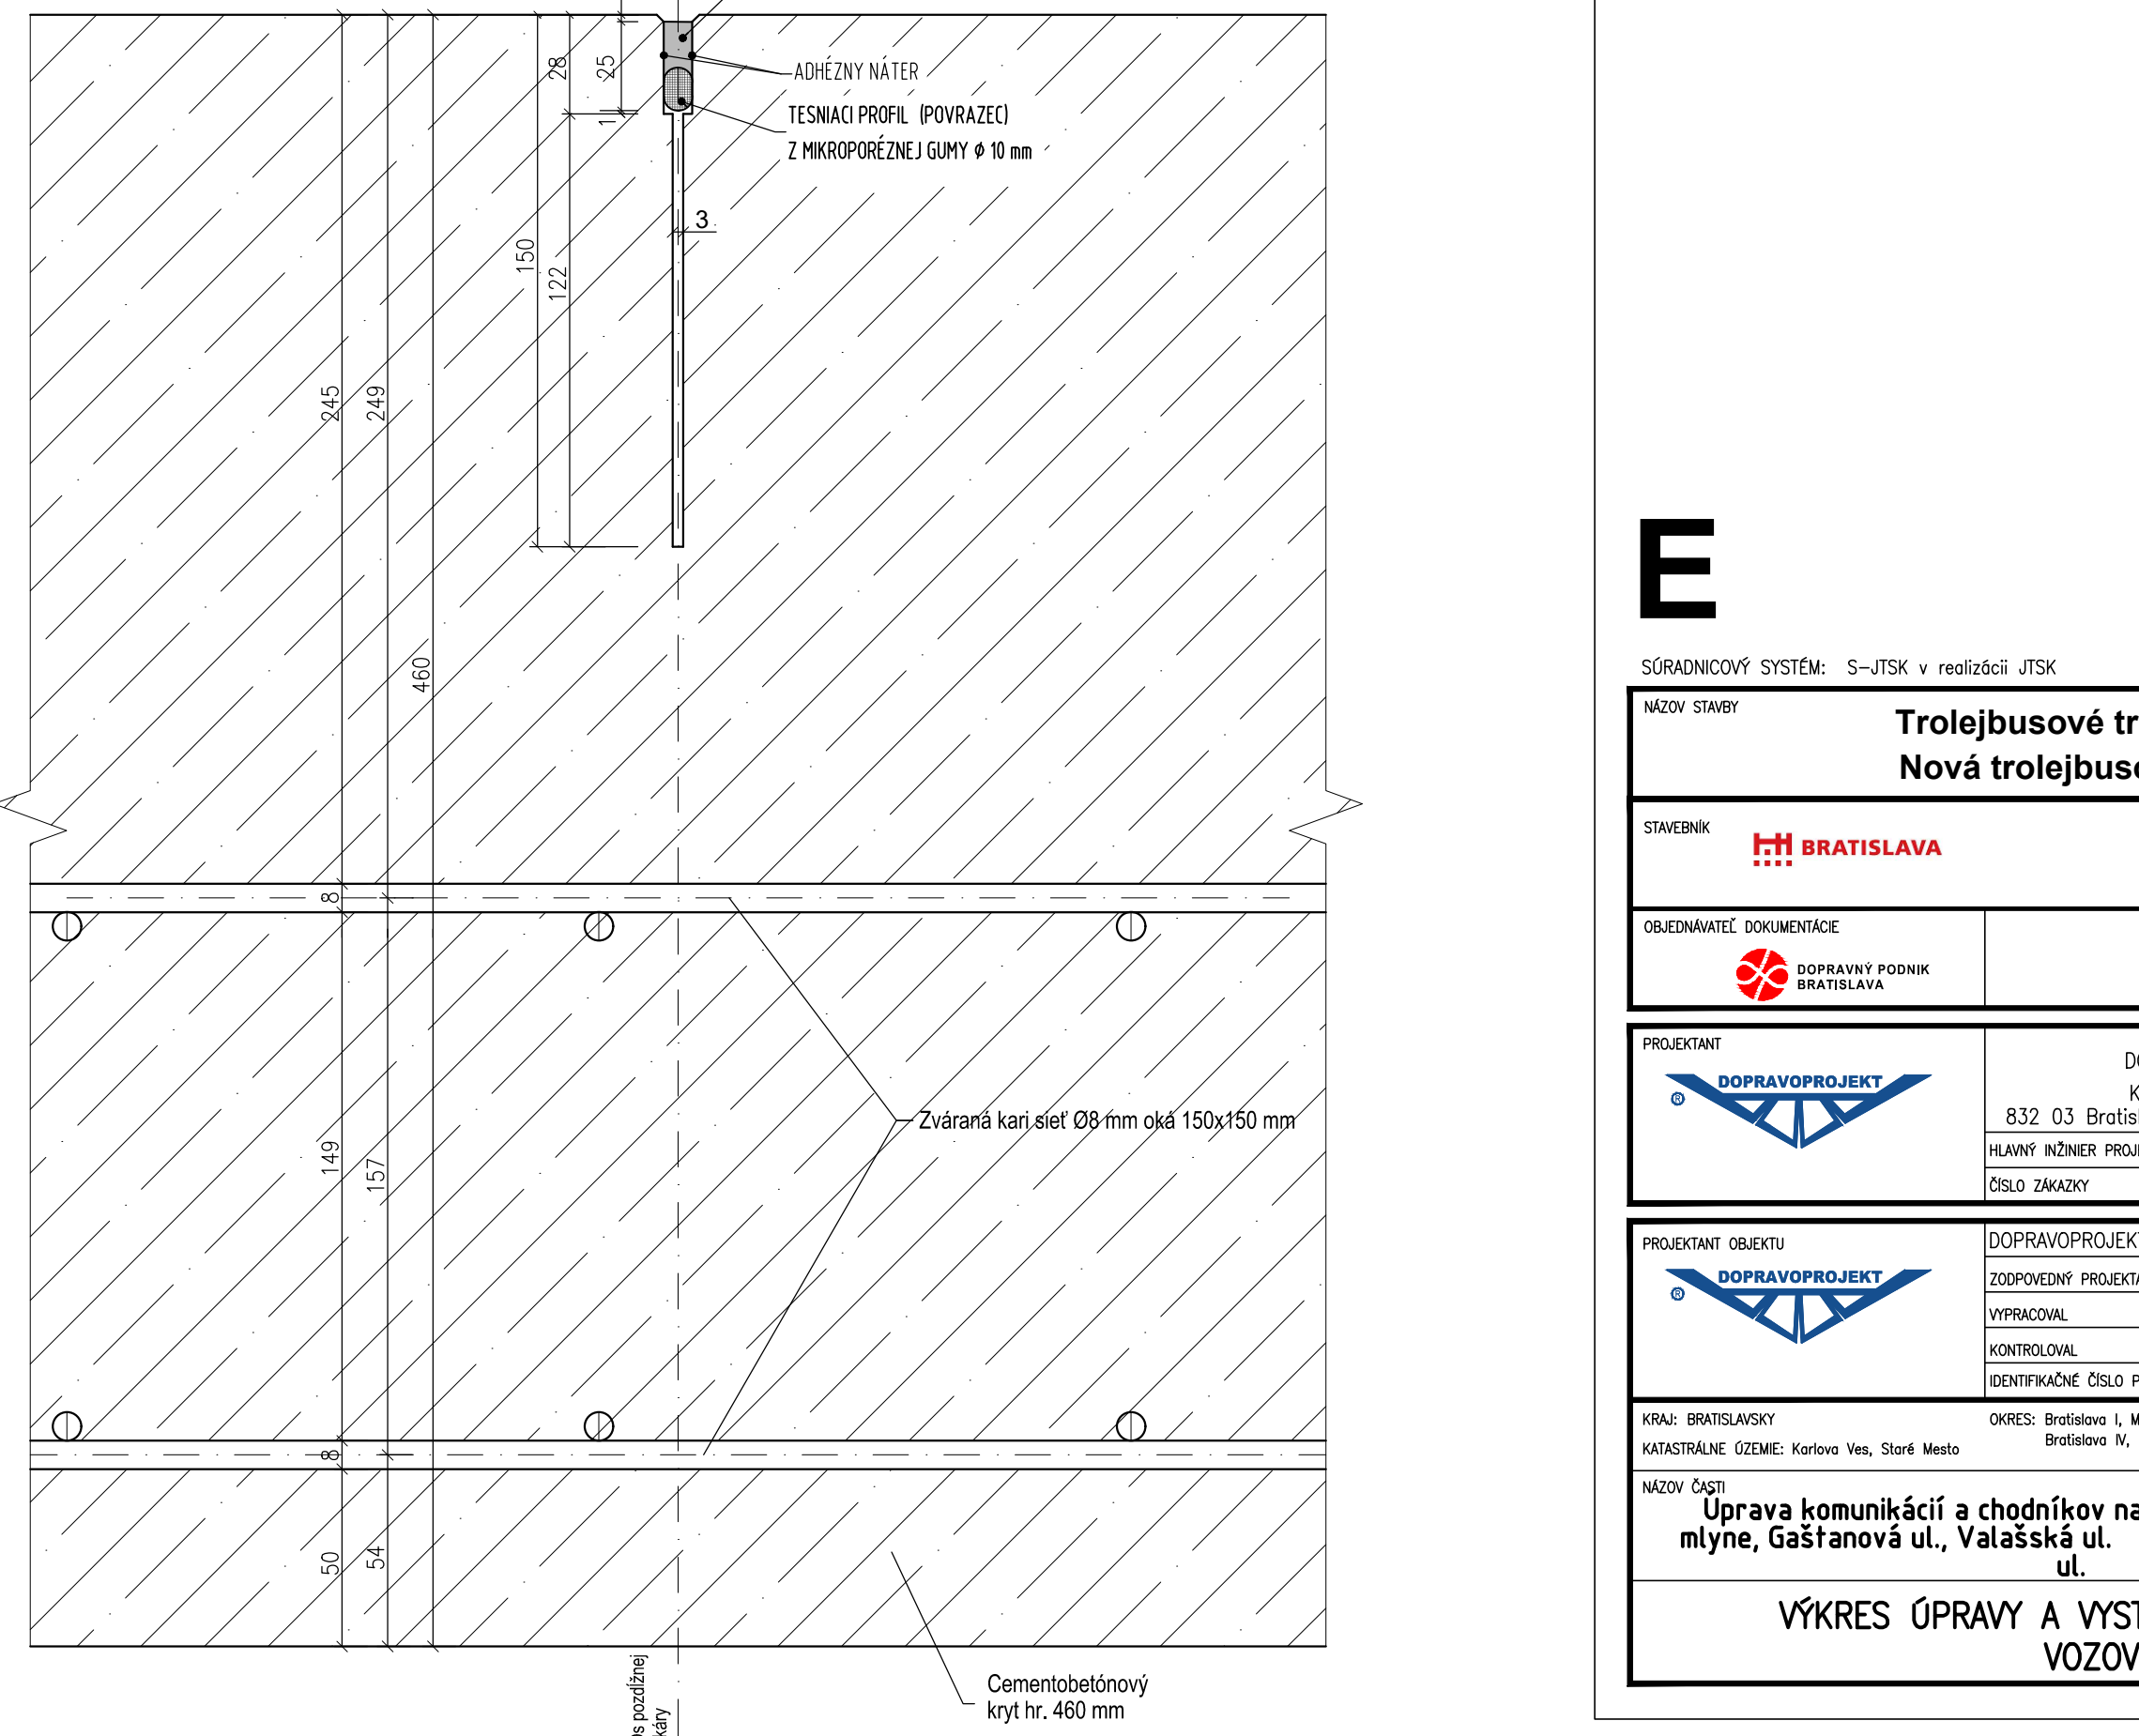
DETAIL POZDĹŽNEJ ŠKÁRY NAD KARI SIEŤOU 1:2 (kótované v mm)
